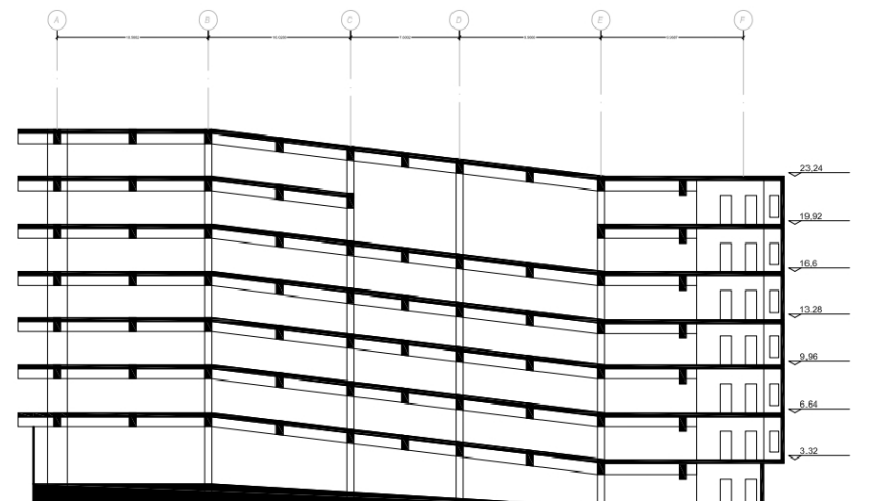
Corte A estado actual. Elaboración propia, basado en el levantamiento del edificio existente.
